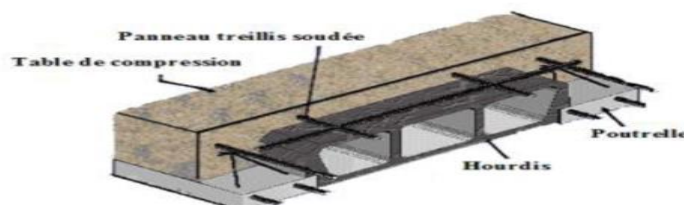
Coupe transversale d'un plancher à corps creux.
